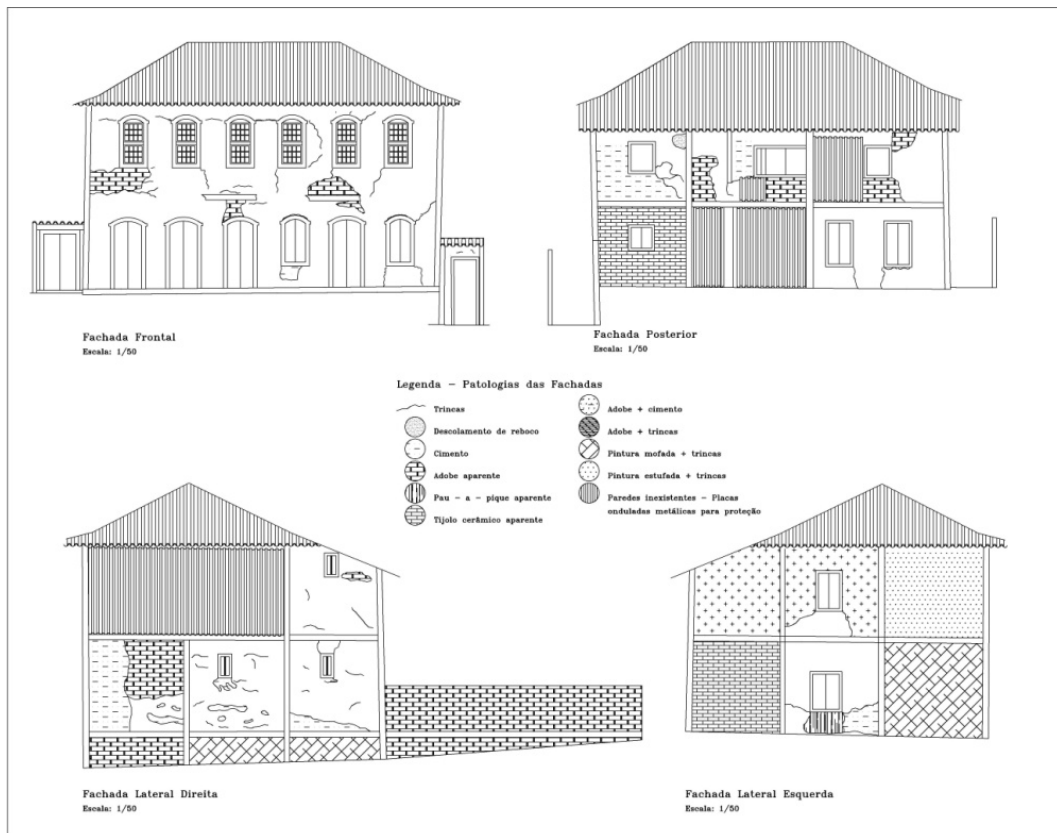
Levantamento das fachadas, realizado em 2010/11 do Sobrado do Cartório. (Fonte: Peixoto, 2011)
